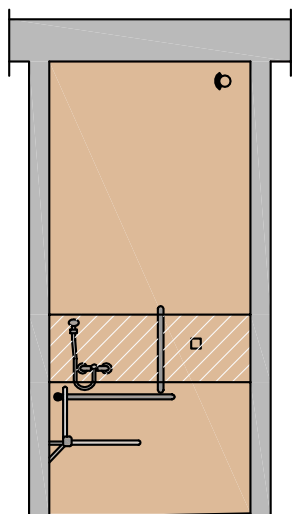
Vista en planta de un aseo accesible con ducha enrasada.
